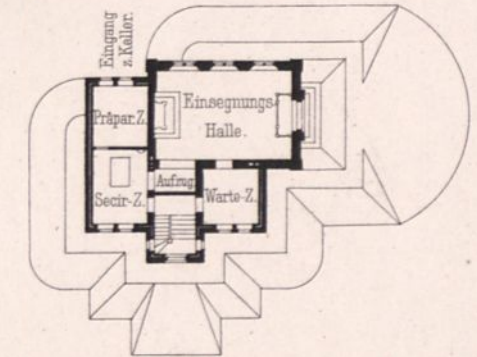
Leichenhaus. Grundriss des Hauptgeschosses.
